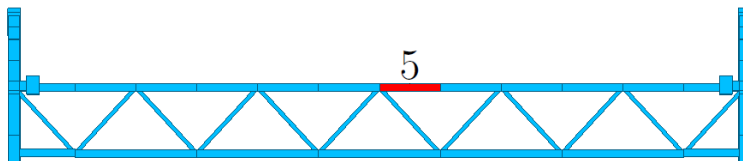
Étude poussée d'un élément au sein de la poutre transversale Nord.
